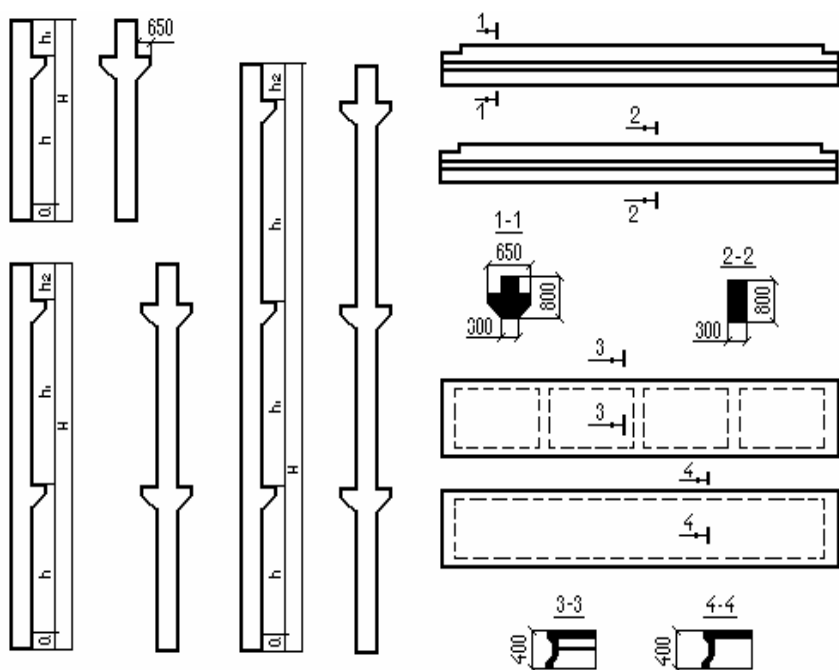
Конструкции колонн, ригелей и плит перекрытий многоэтажных производственных зданий
